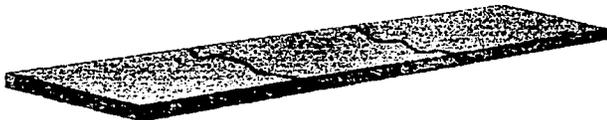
Agrietamiento inicial en un pavimento de concreto sin juntas.
